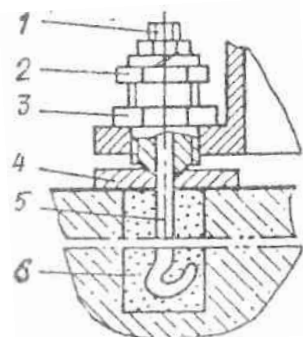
Установка оборудования на винтовой опоре с заливным фундаментом:
